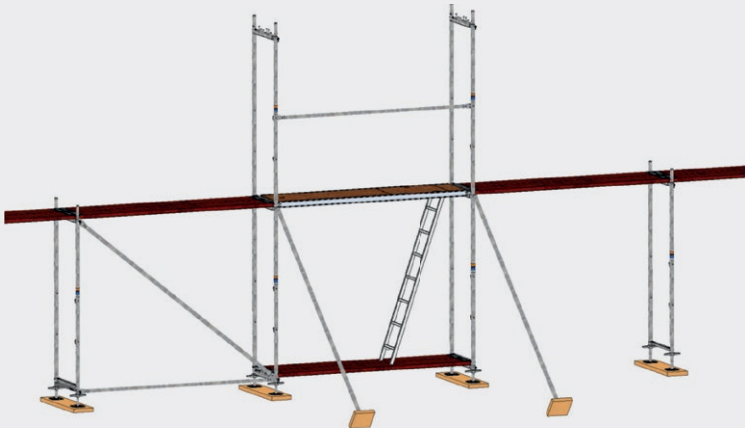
Beispiel für eine vorübergehende Kippsicherung der ersten Gerüstlage.
